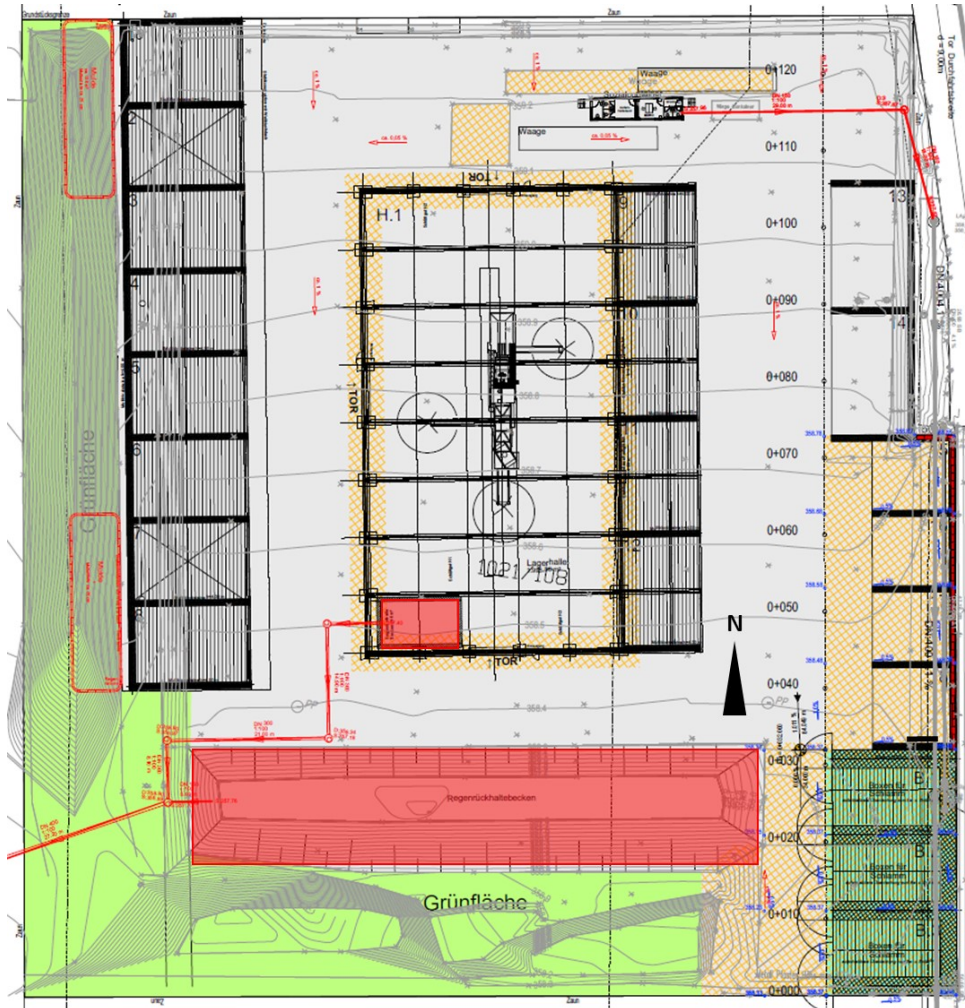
Lageplan der Entwässerungseinrichtungen
